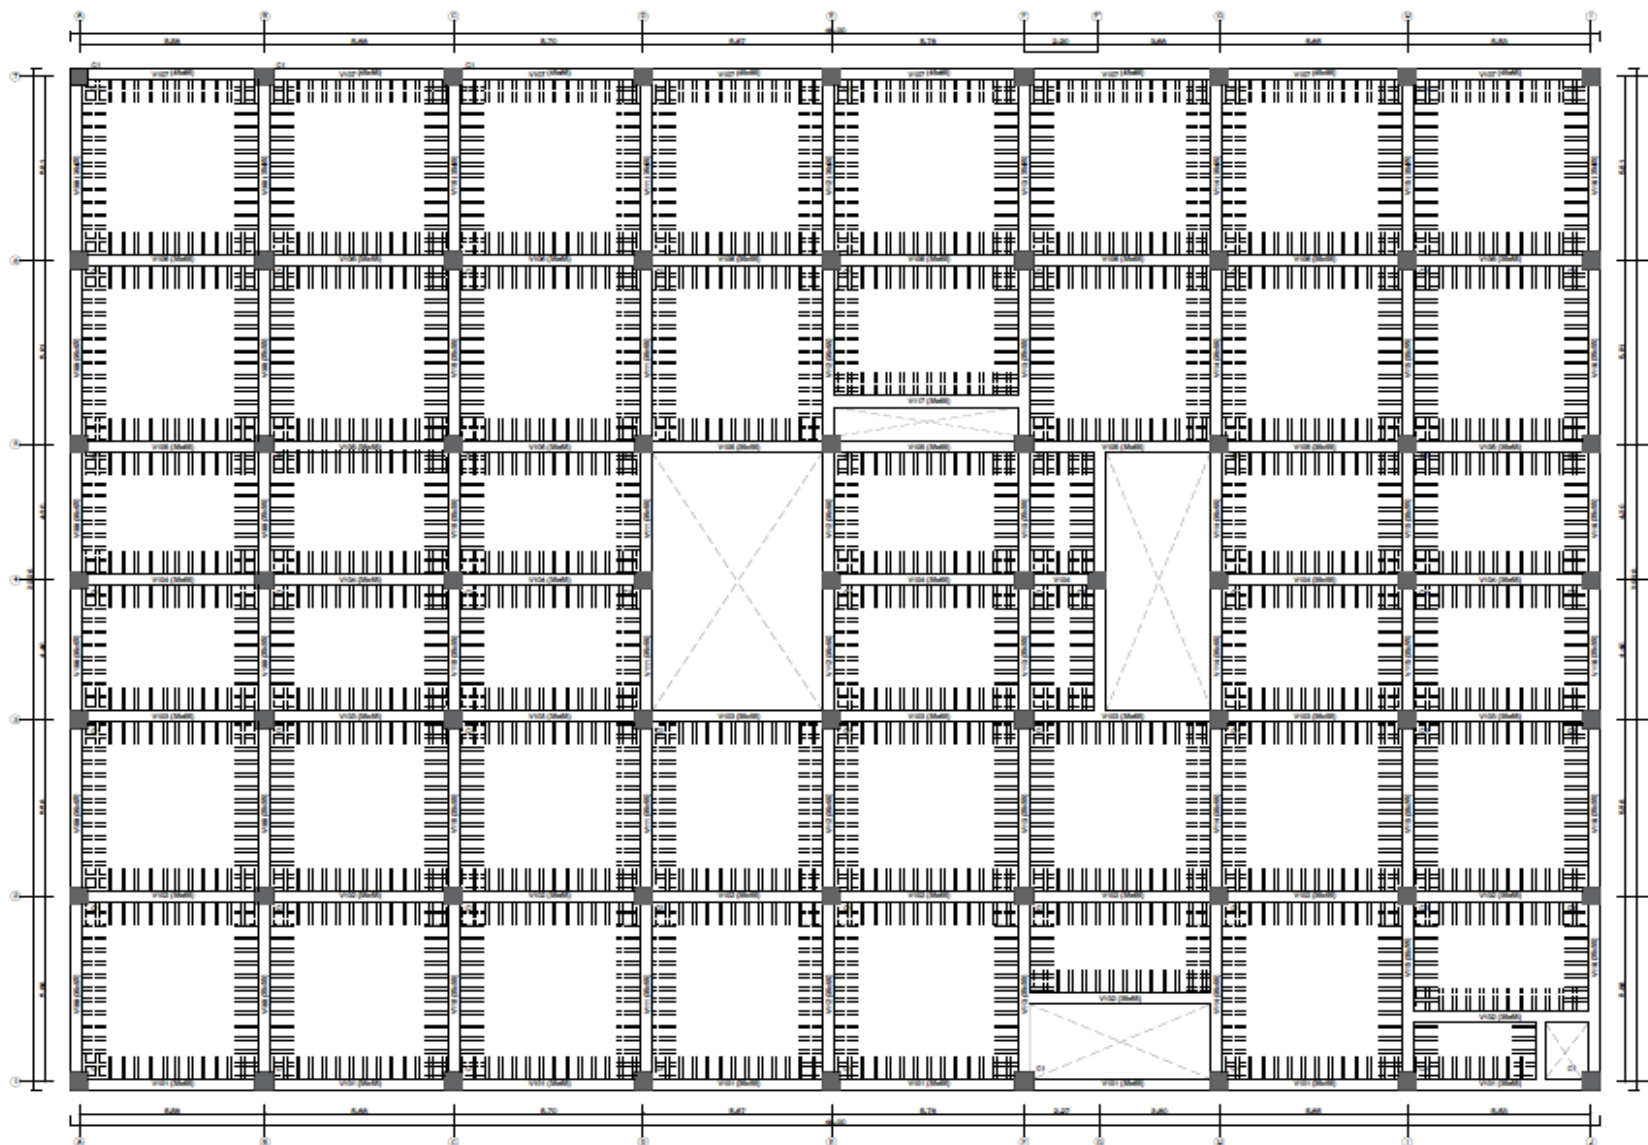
Planta arquitectónica del 3° nivel del establecimiento de Salud.
